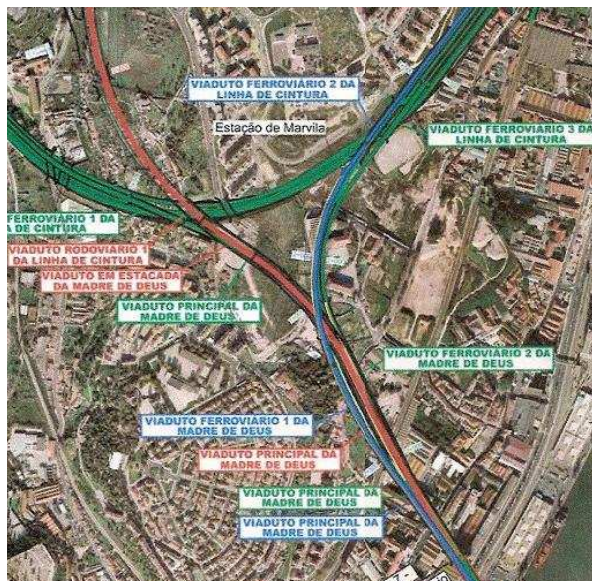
Ponte Chelas-Barreiro (RAVE) - Acessos em Lisboa- Planta
